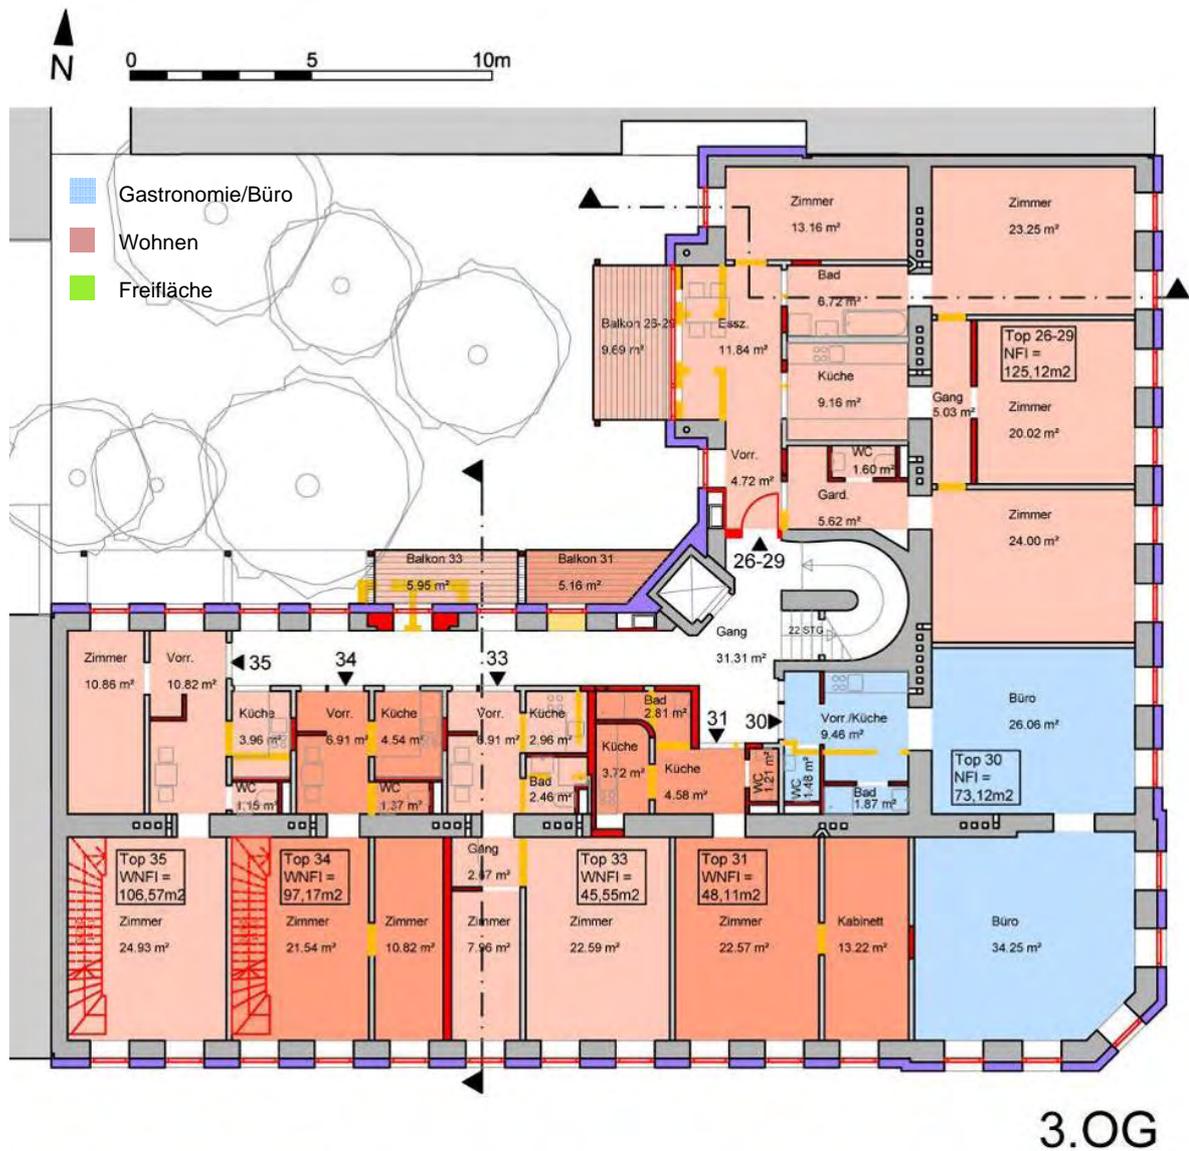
Grundriss 3. Obergeschoß
